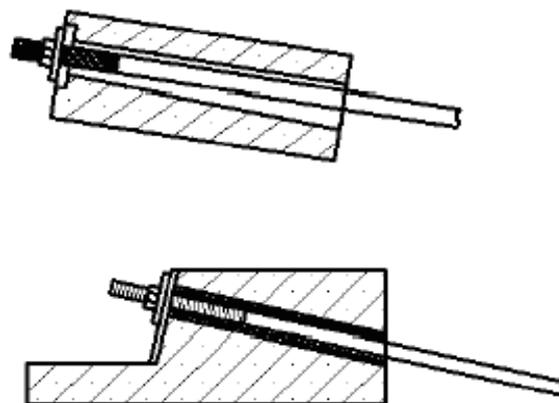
Крепление вантовых канатов к железобетонным конструкциям насквозь
